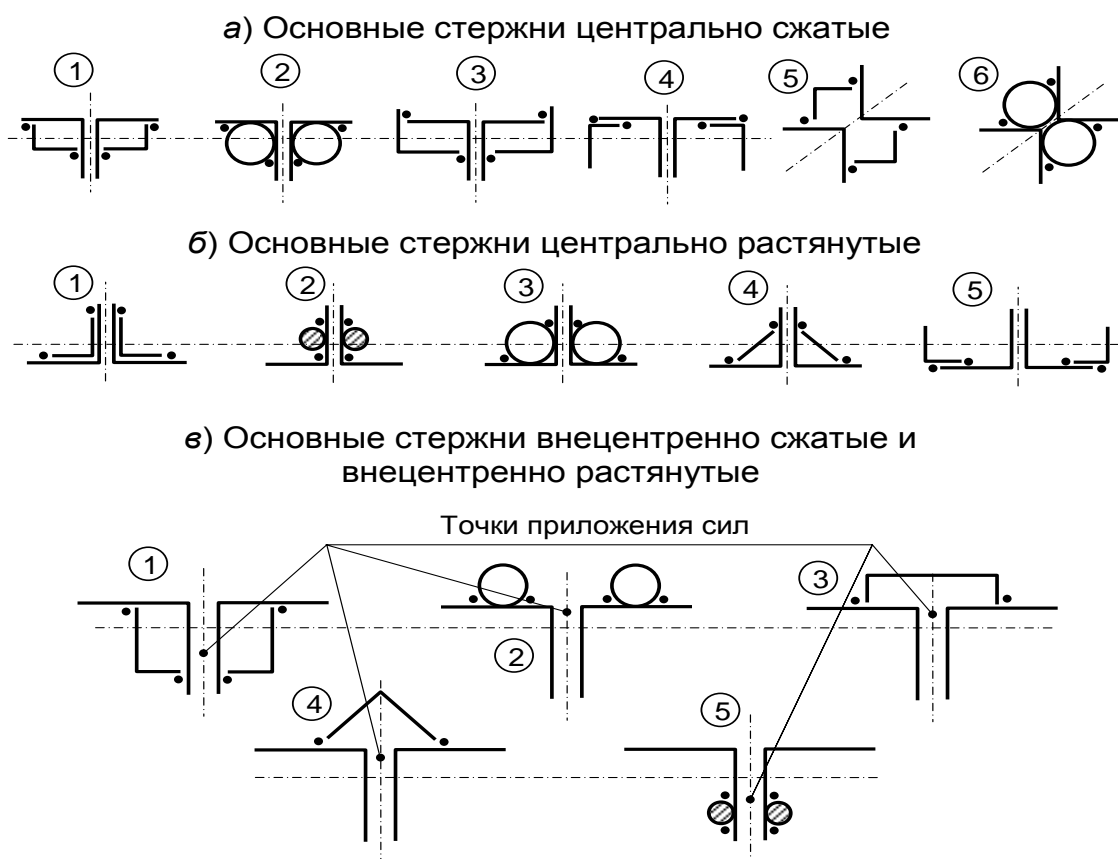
Схемы усиления сжатых стержней стальных стропильных ферм
